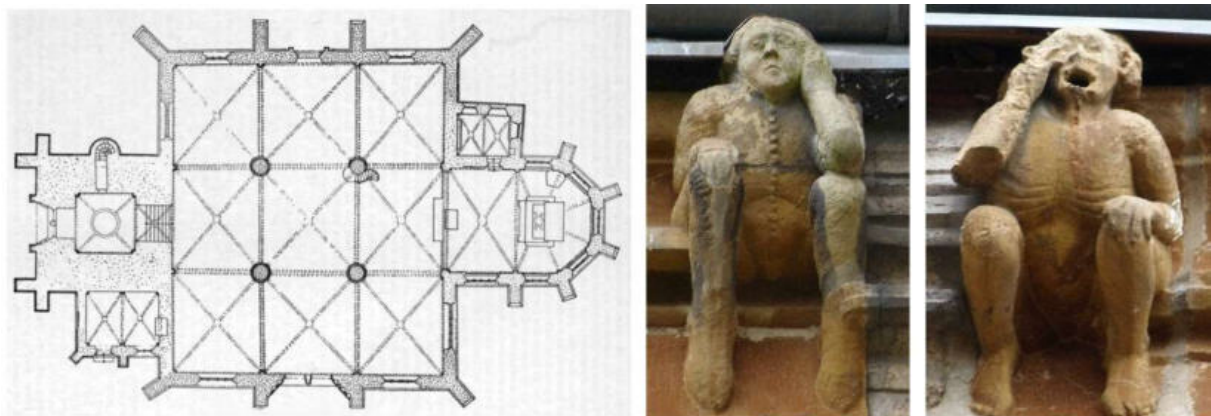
Kilianskirche Korbach – Grundriss, Dachgesims-Männer
